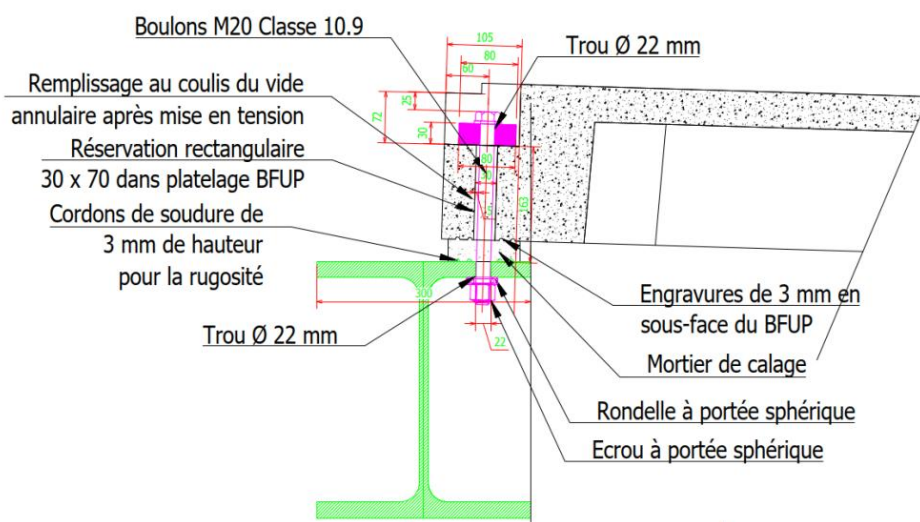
Détail de la fixation par boulon précontraint du platelage sur console
